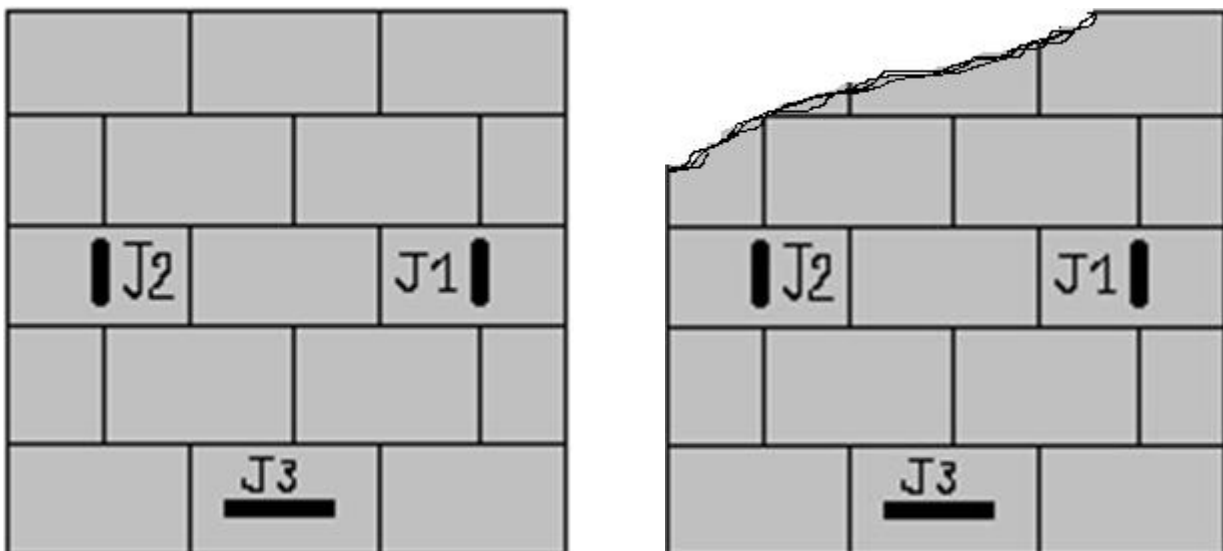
Emplacement des jauges pour l'essai n°14. Fig. IV.96. Rupture mur 12 trous de l'essai n°14.
